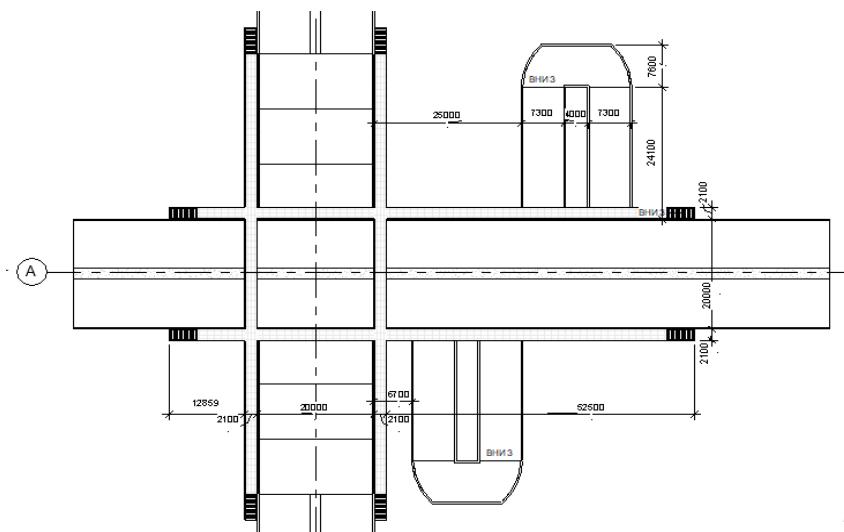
архитектурно-планировочное решение (план площадки)
